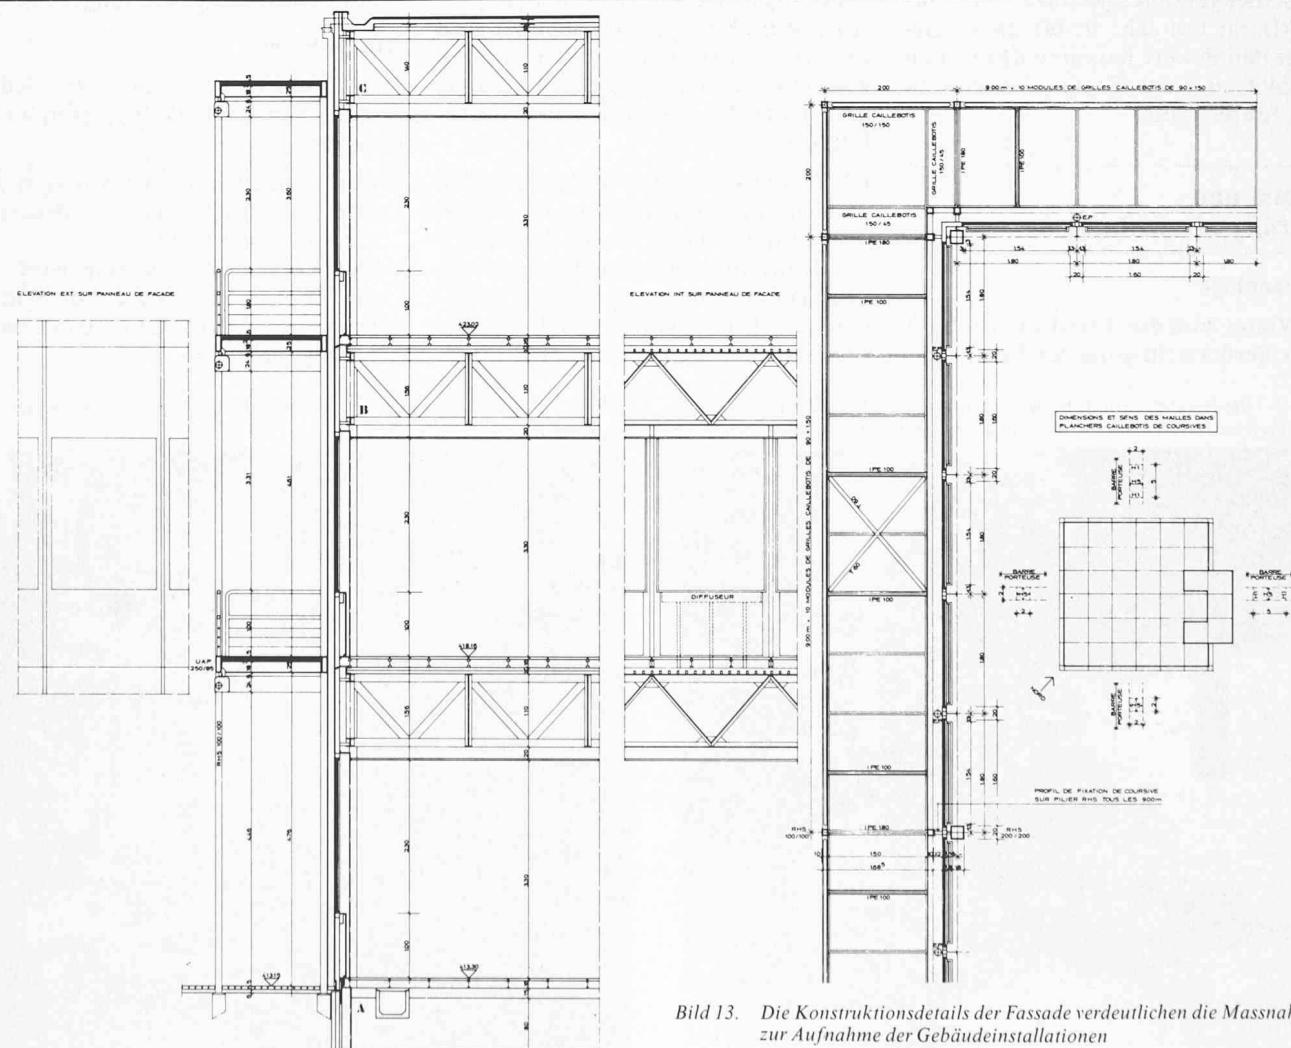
Die Konstruktionsdetails der Fassade verdeutlichen die Massnahmen zur Aufnahme der Gebäudeinstallationen
